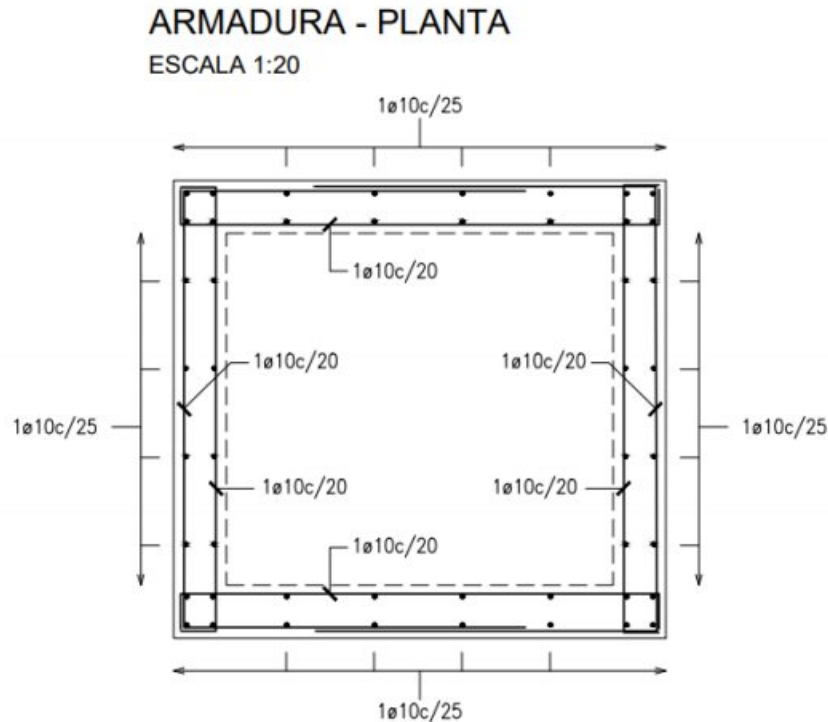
Armaduras de cámara de caída en planta. Fuente: Elaboración propia.
